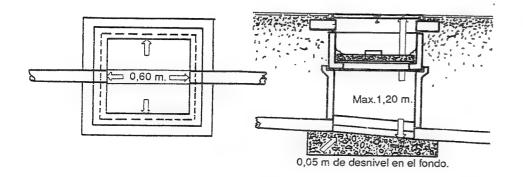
VII Cámara de inspección de mampostería 0,60 x 1.00m.
